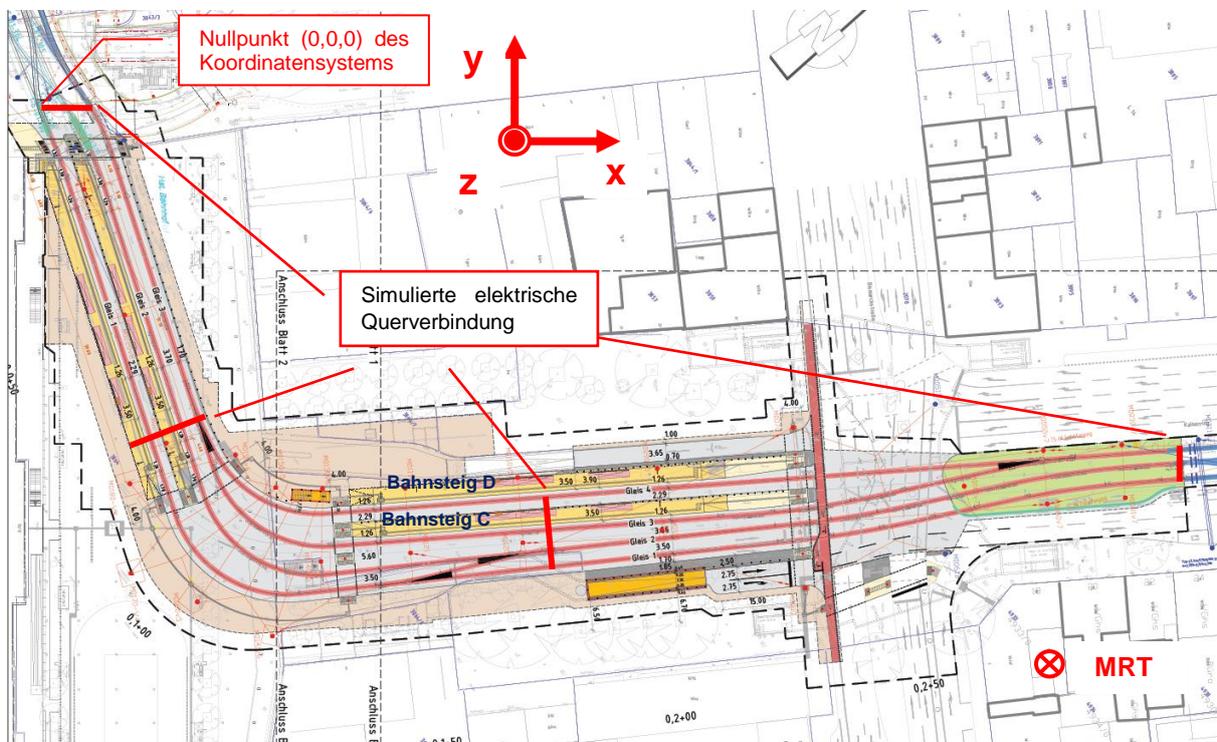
Lageplan mit Koordinatensystem (schematische Darstellung der Querverbindungen)
